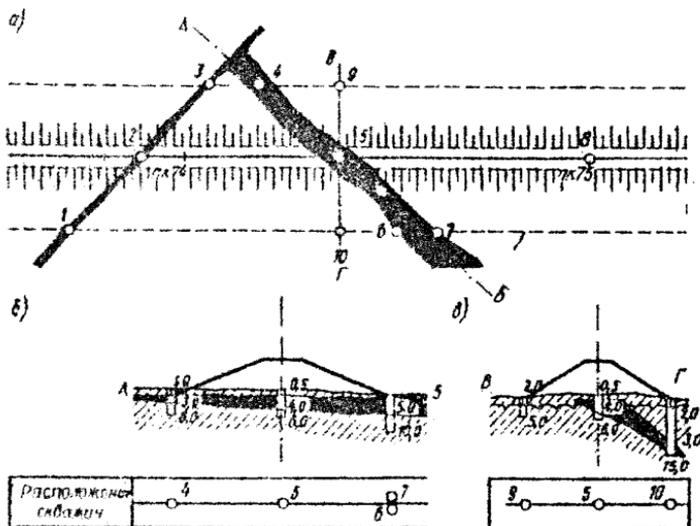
Примерная схема разведки ледяных или грунтовых хил на участке пересечения их контуром проектной насыпи: а- план; б- продольный разрез по оси ледяной (грунтовой) хилы; в- поперечный профиль в месте пересечения хилы осью трассы
